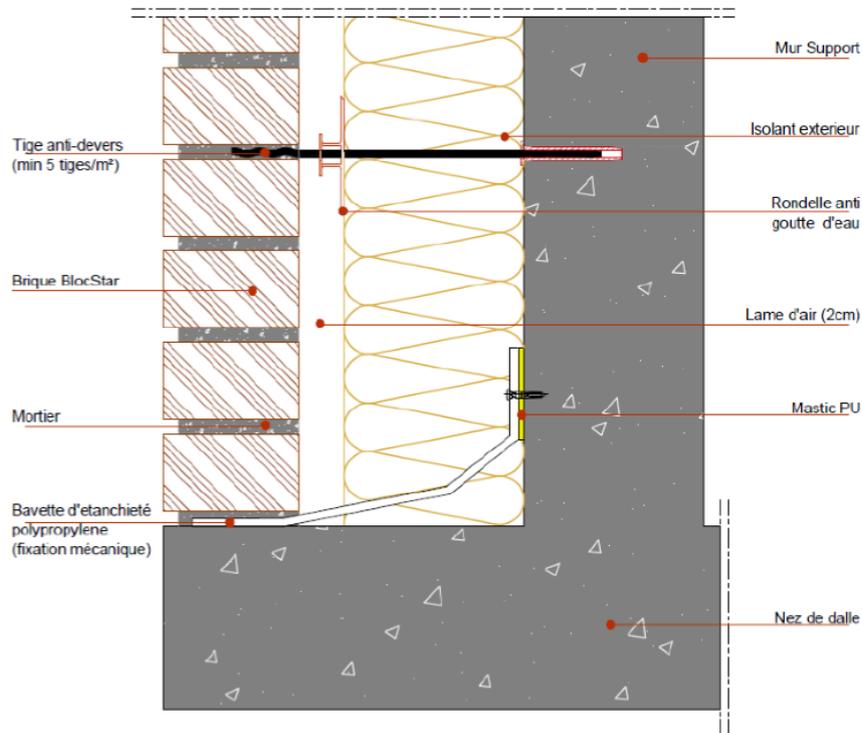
Appui du 1^{er} rang sur fondation, dalle ou corbeau béton (3 niveaux filants maximum)
